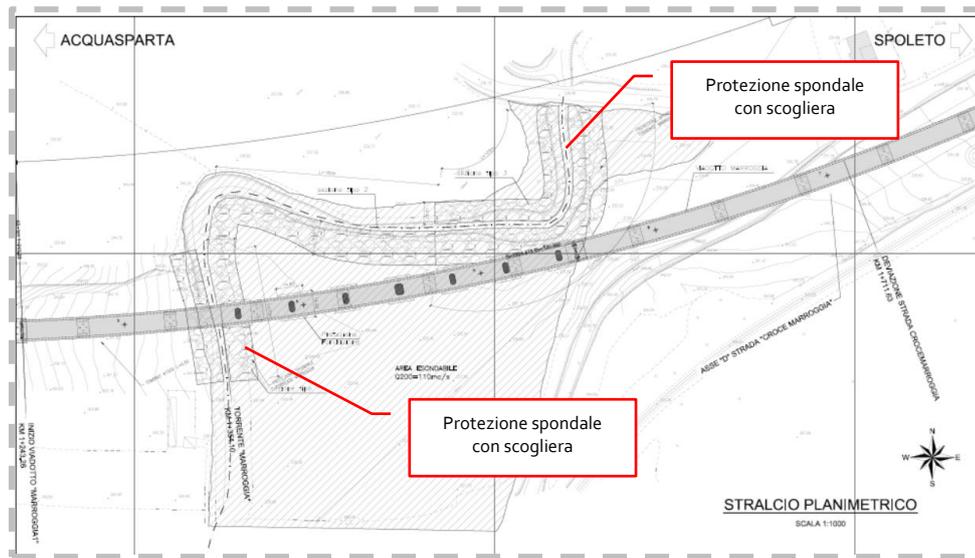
Opere di difesa spondale del Torrente Marroggia PE: planimetria
